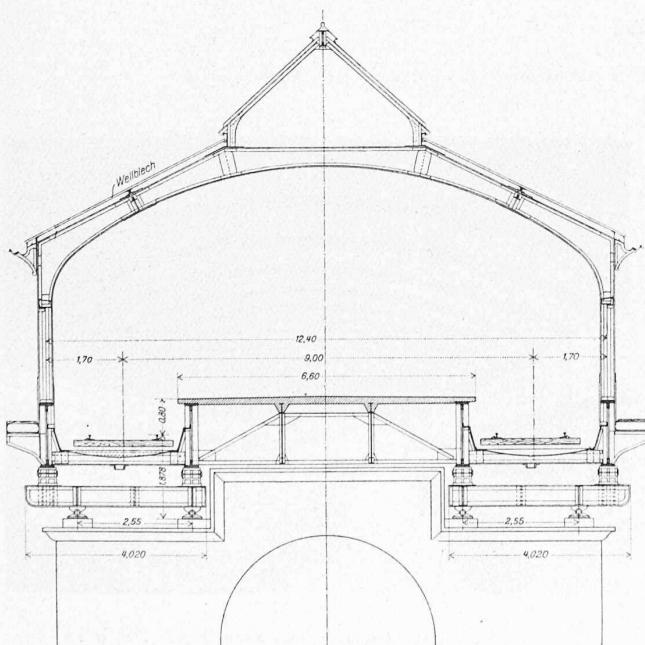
Bahnsteighalle der Haltestelle Danzigerstrasse der Berliner Hoch- und Untergrundbahn. — 1:150.
